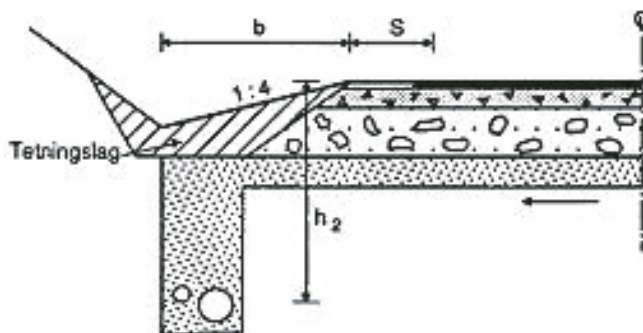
Grunn drenergrøft med grove drenerende materialer
